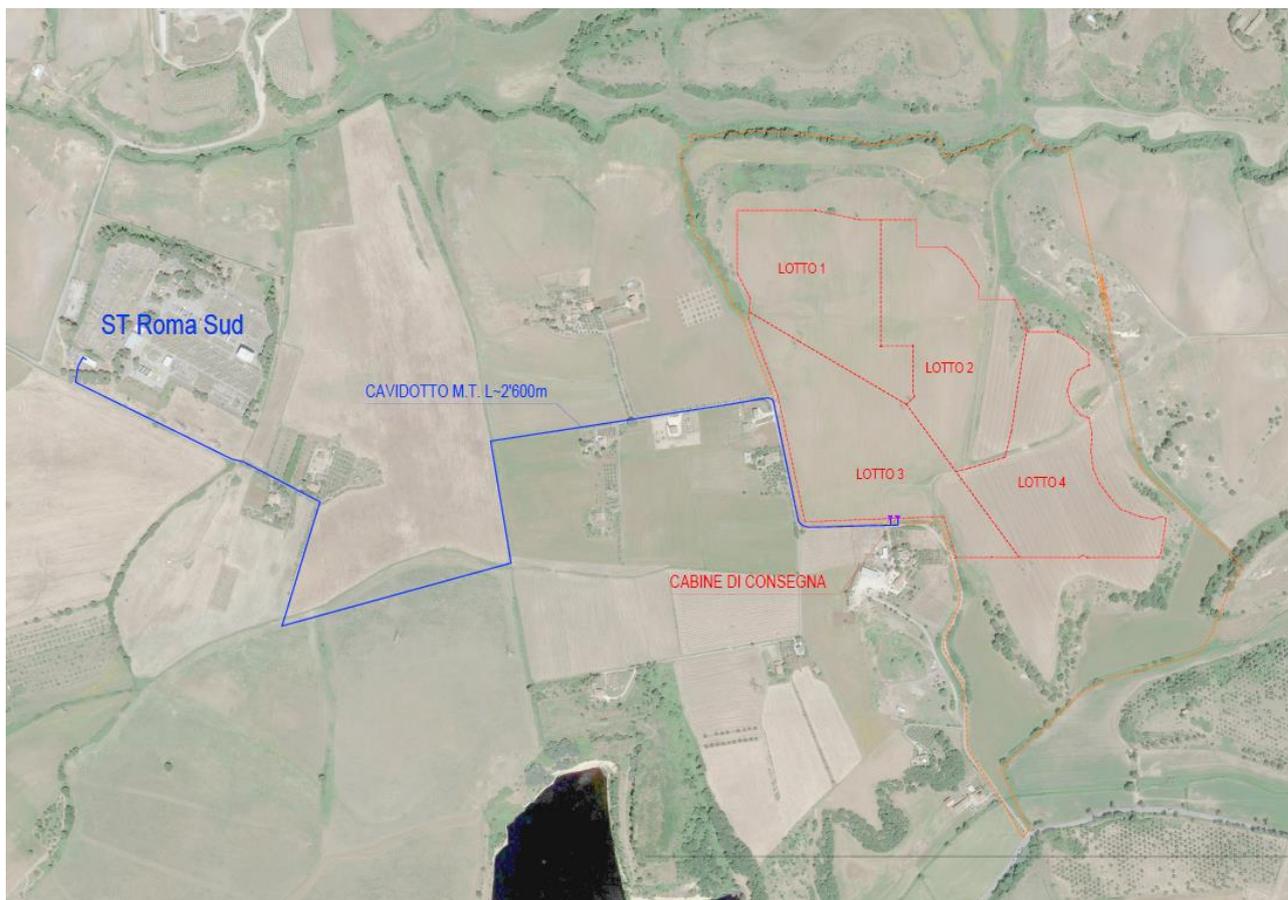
Inquadramento delle opere di connessione su Ortofoto
